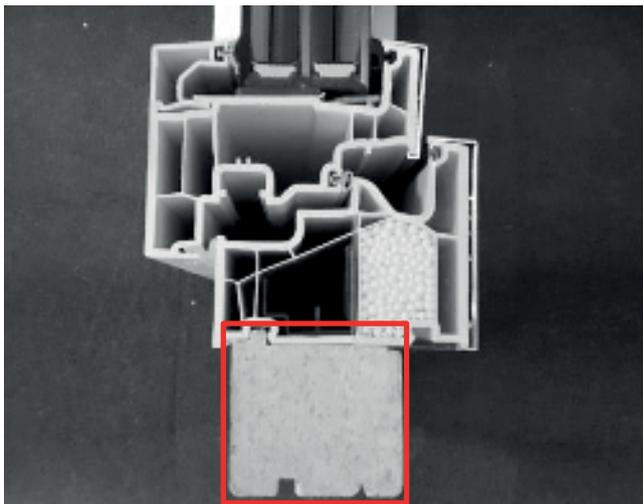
Beispiel für ein Fenster mit einem ausreichend hohen, ebenen und dämmenden Fensterbankanschlußprofil (roter Rahmen)
